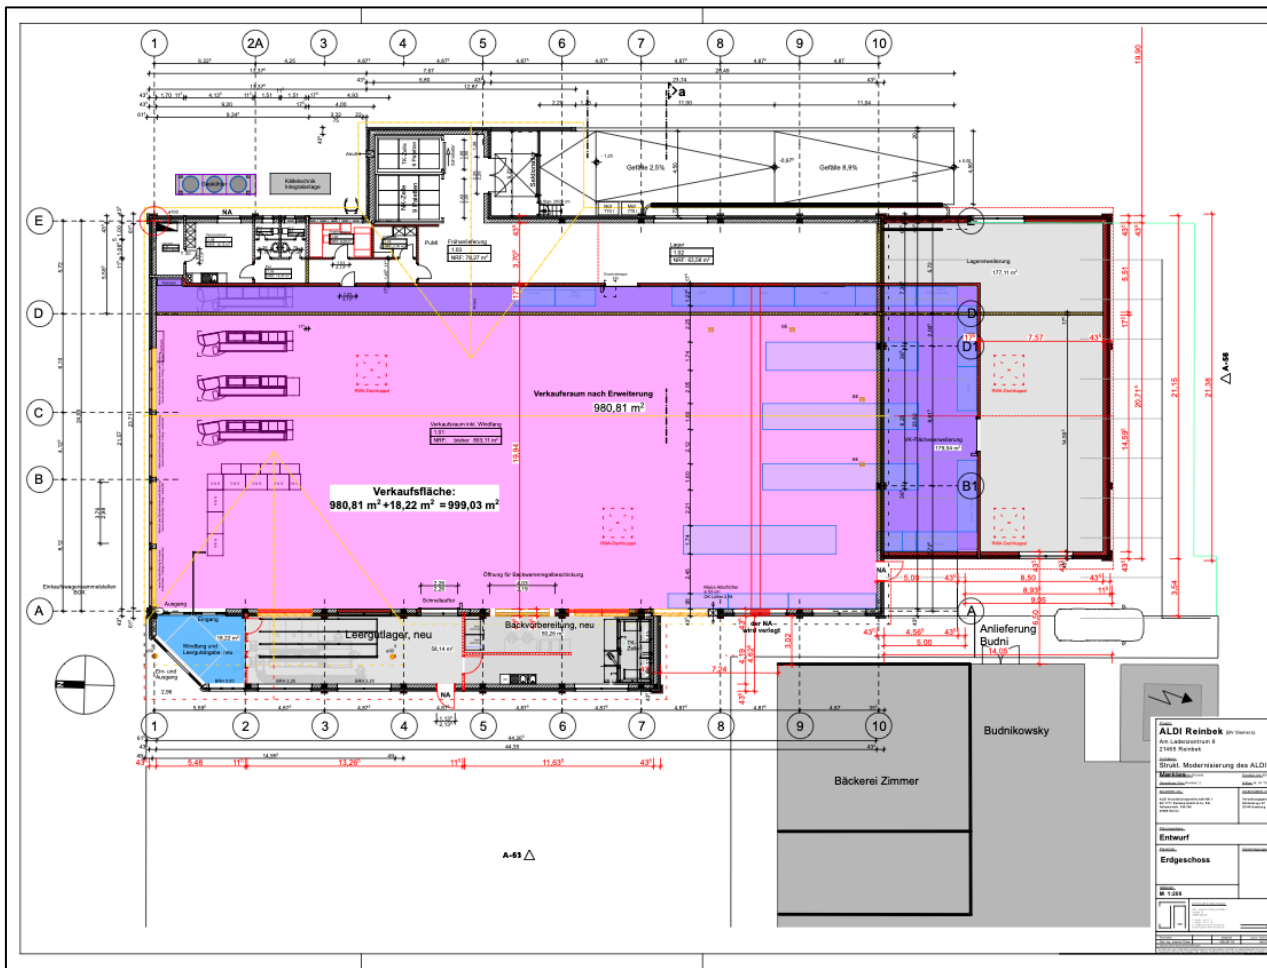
Entwurf Lageplan (Quelle: JTA – Joachim Tidow | Architekt)
